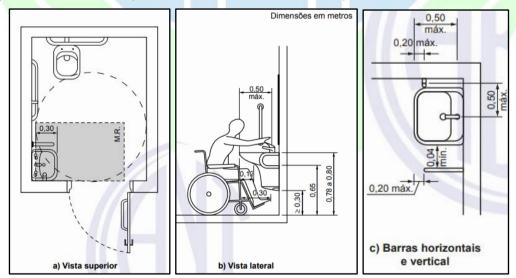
Dimensões para instalação das barras de apoio para lavatório conforme NBR 9050/2020
